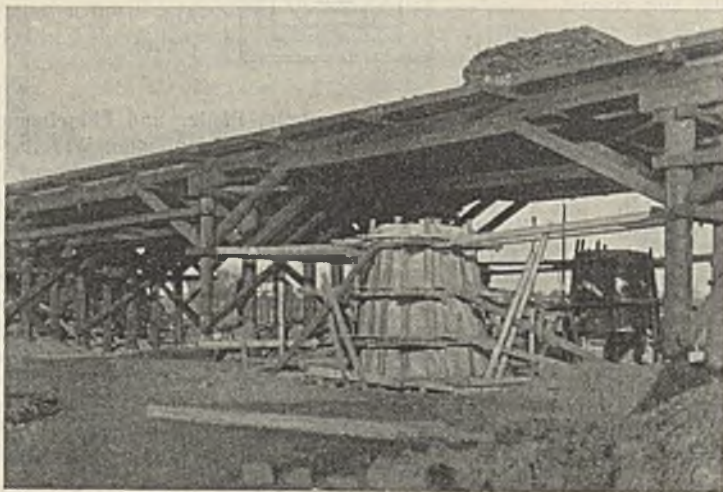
Eingeschalter Pfeiler unter der alten Holzbrücke.
